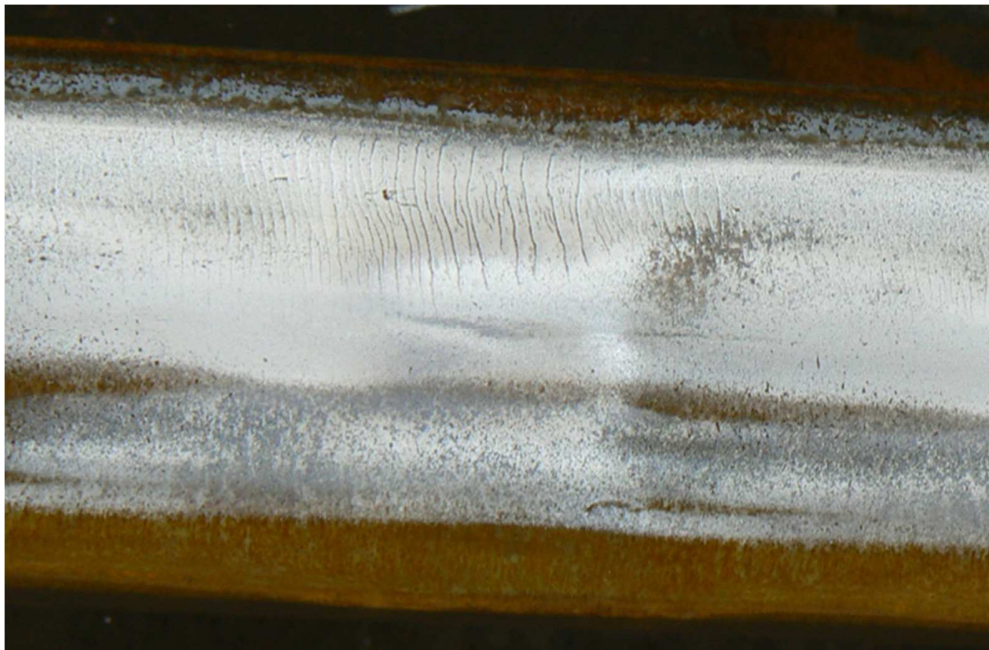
Fisuras transversales sobre el hongo sobre vía en el Pk 10,885
